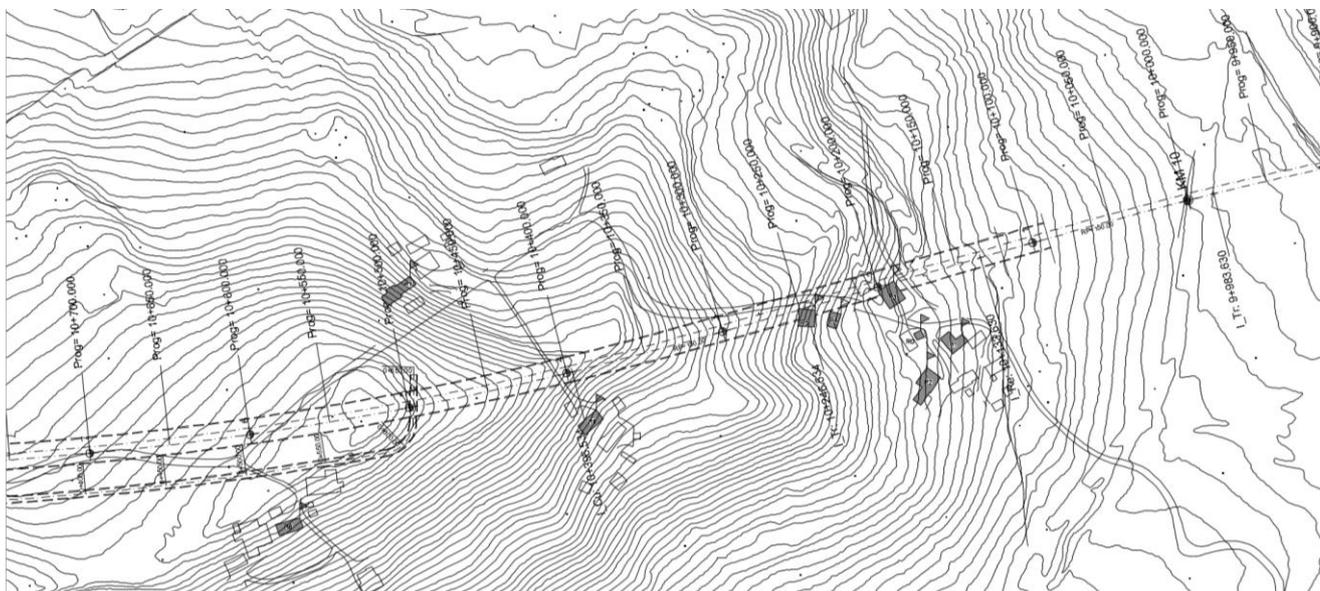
Planimetria posizione edifici zona galleria Rocchetta e Finestra F5
